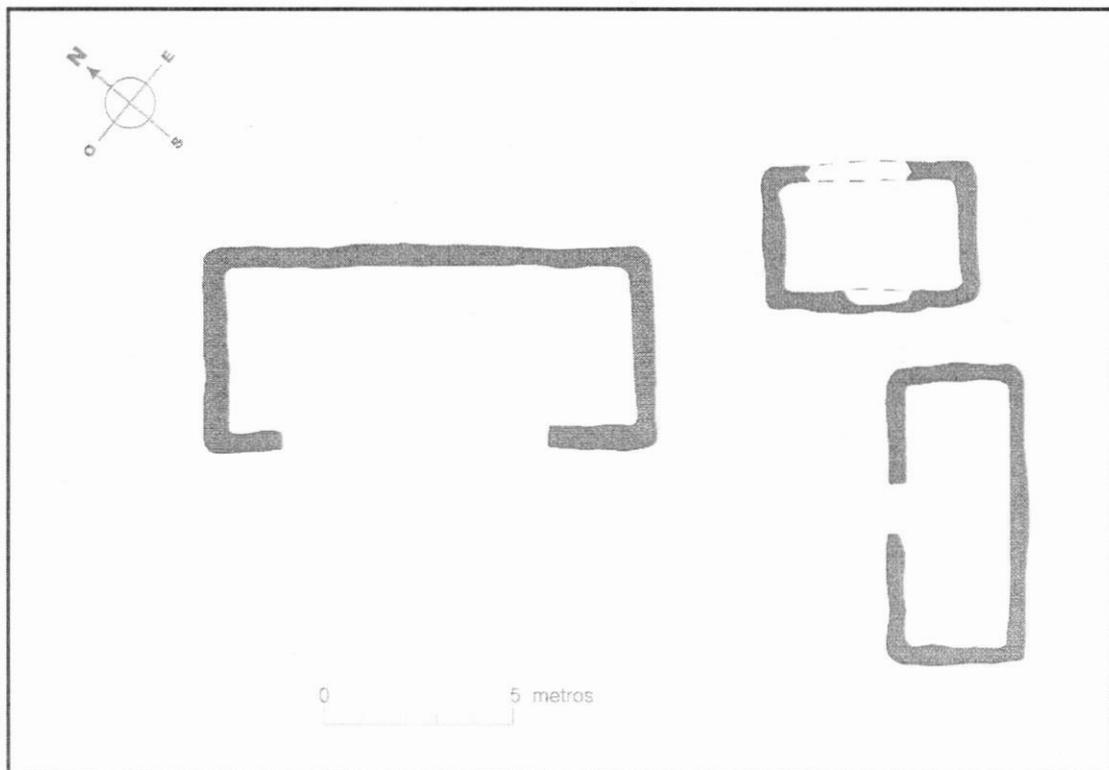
Plano de Los Paredones (dibujado de Lennon, Cornejo y Church 1986: 59).
